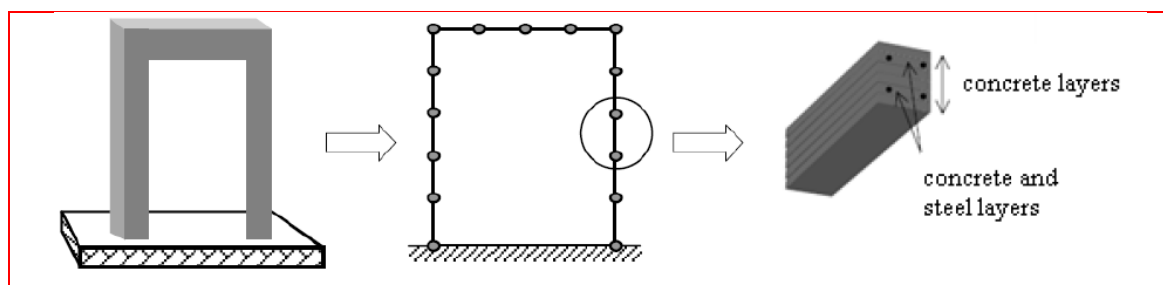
Principe de discrétisation des structures en béton armé en poutres multicouches
